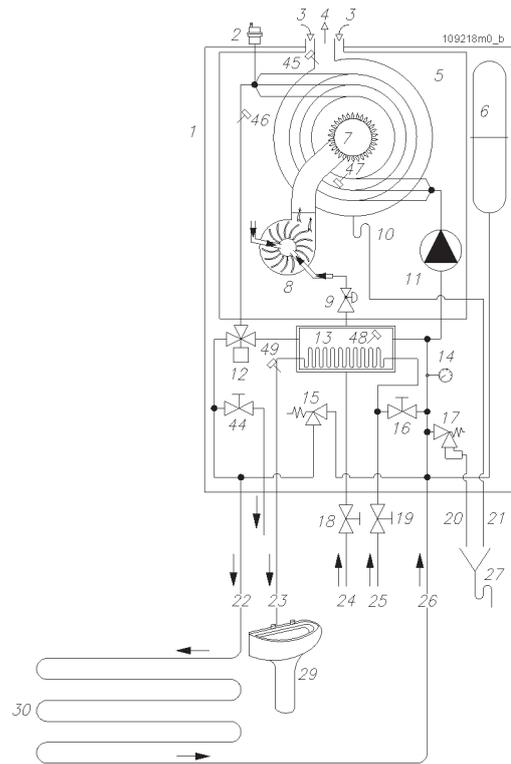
Hydraulikplan Serie WKM mit integrierter Warmwasserbereitung und Fußbodenheizung.
